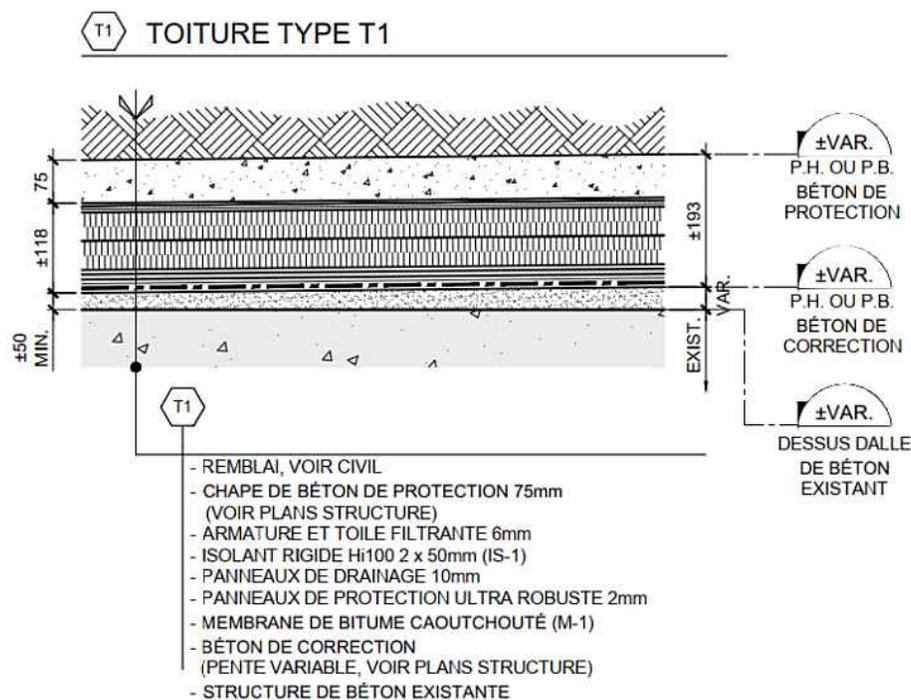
Travaux d'imperméabilisation du tunnel, STM 2020.
